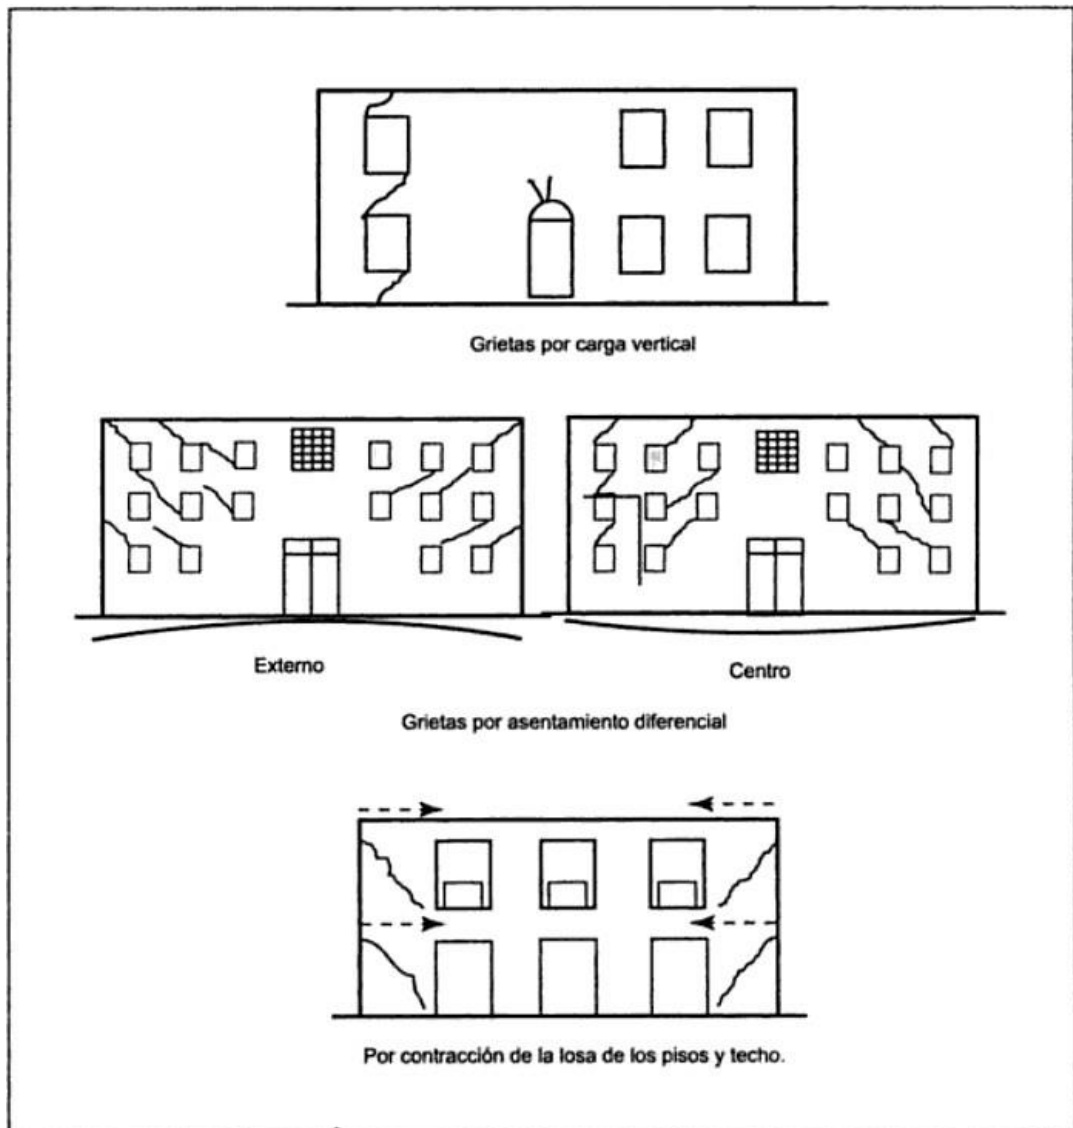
Agrietamiento típico en las fachadas de edificios de albañilería.
